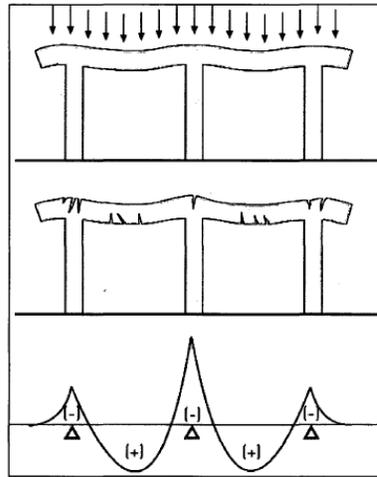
Esquema de fisuración de las vigas de un Pórtico de concreto armado debido a la flexión
